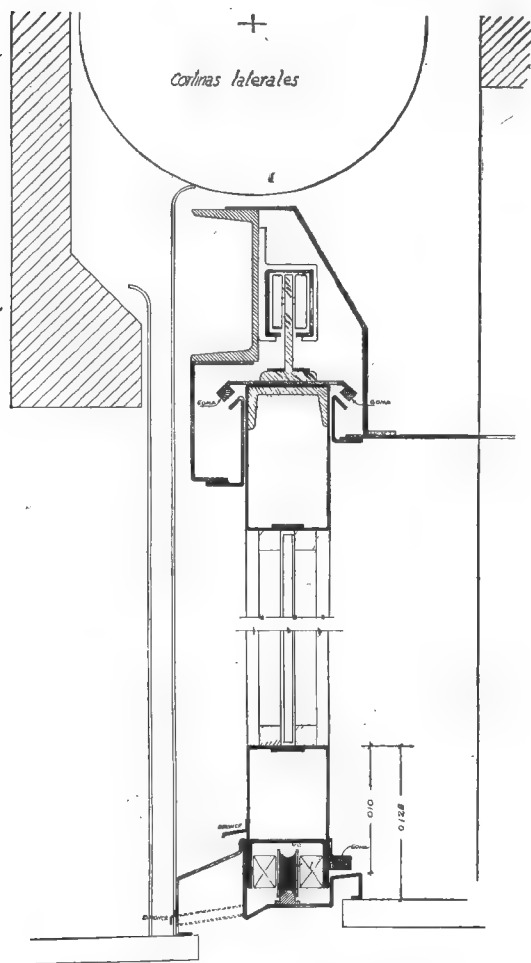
Detalle de carpintería metálica (aberturas pisos 10 y 22)
